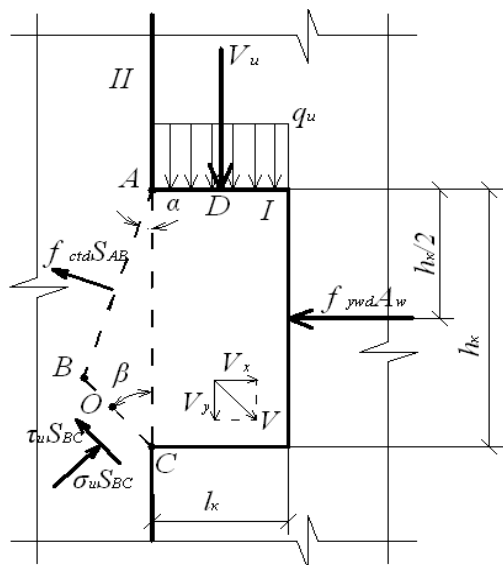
Кінематично можлива схема руйнування контактного залізобетонного шва
